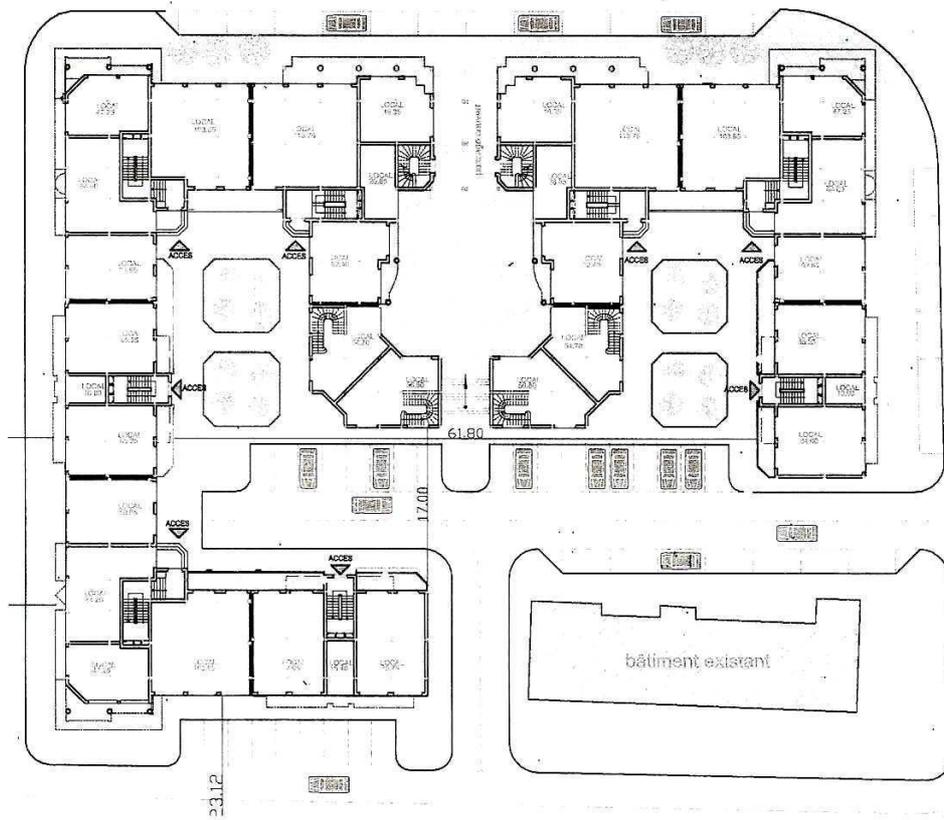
Plan du rez-de-chaussée des immeubles LSP - échelle : 1/800 -
